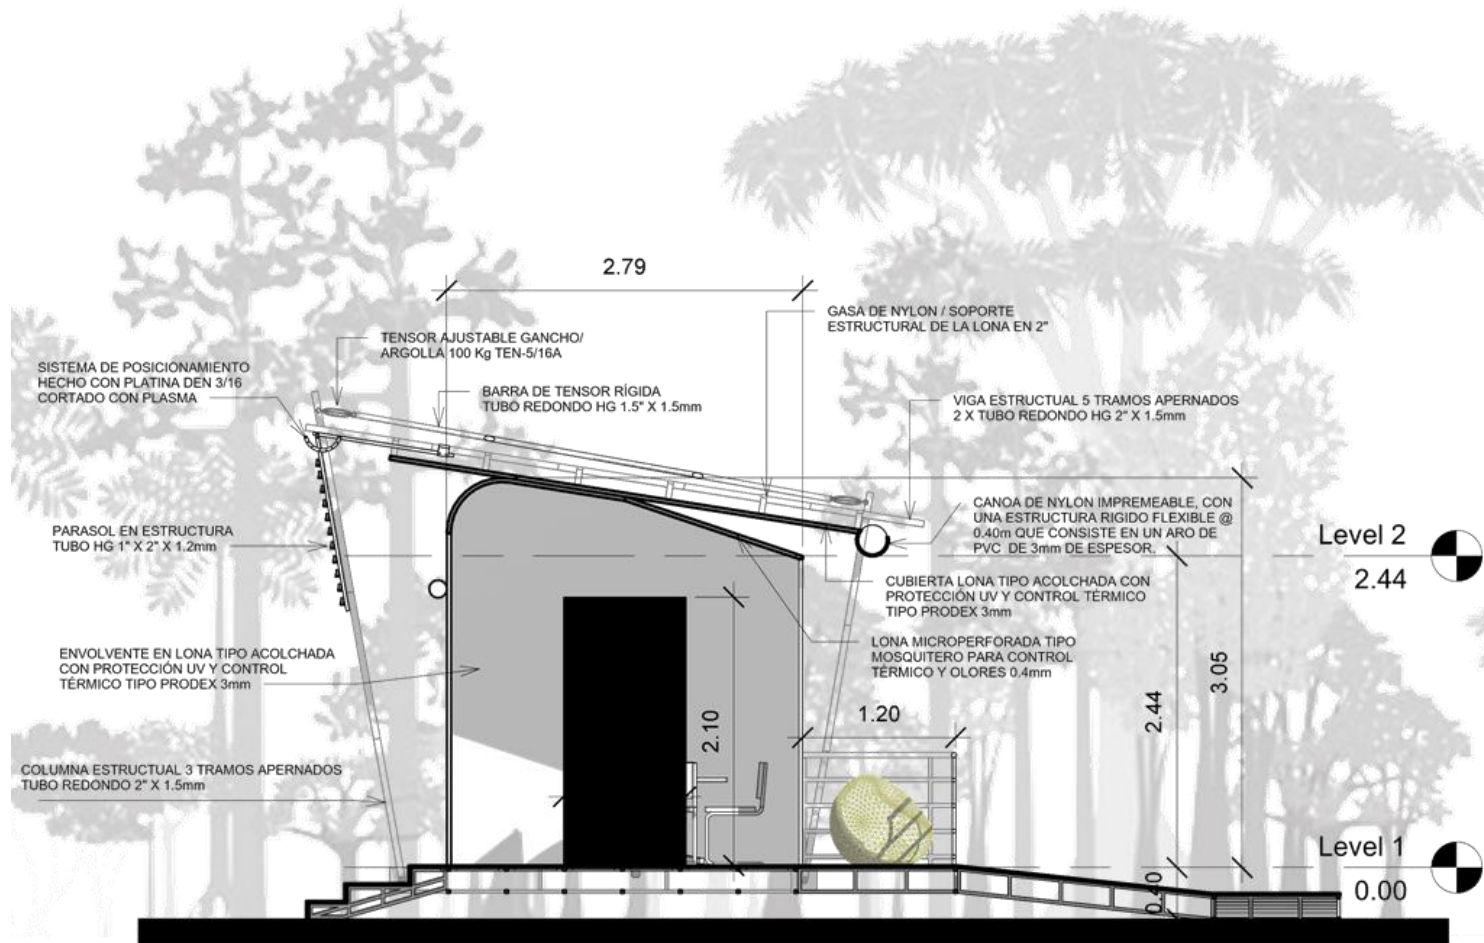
Corte arquitectónico transversal. Elaboración propia.
